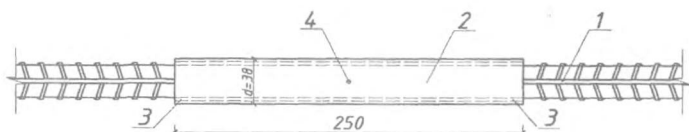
Конструкция муфтового соединения стержневой арматуры (Тип № 1):
